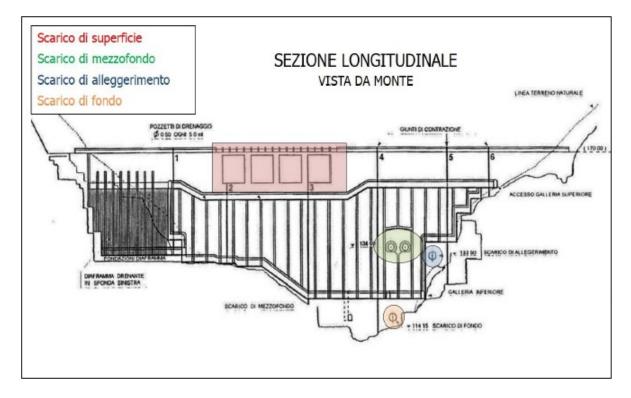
Sezione longitudinale del paramento di monte della diga di Muzzone.
